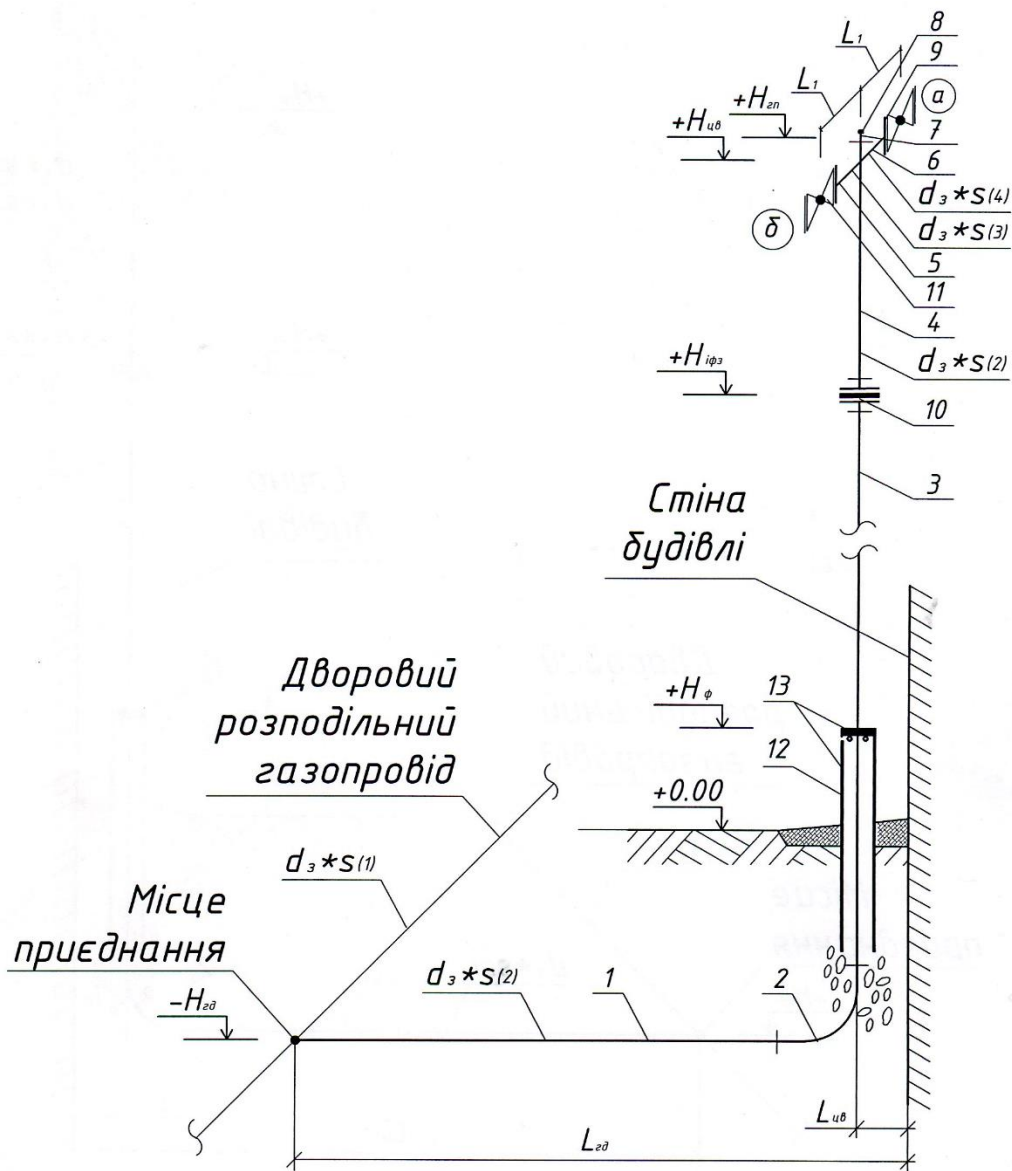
Монтажна схема газопроводу-вводу «сталь – сталь»:
